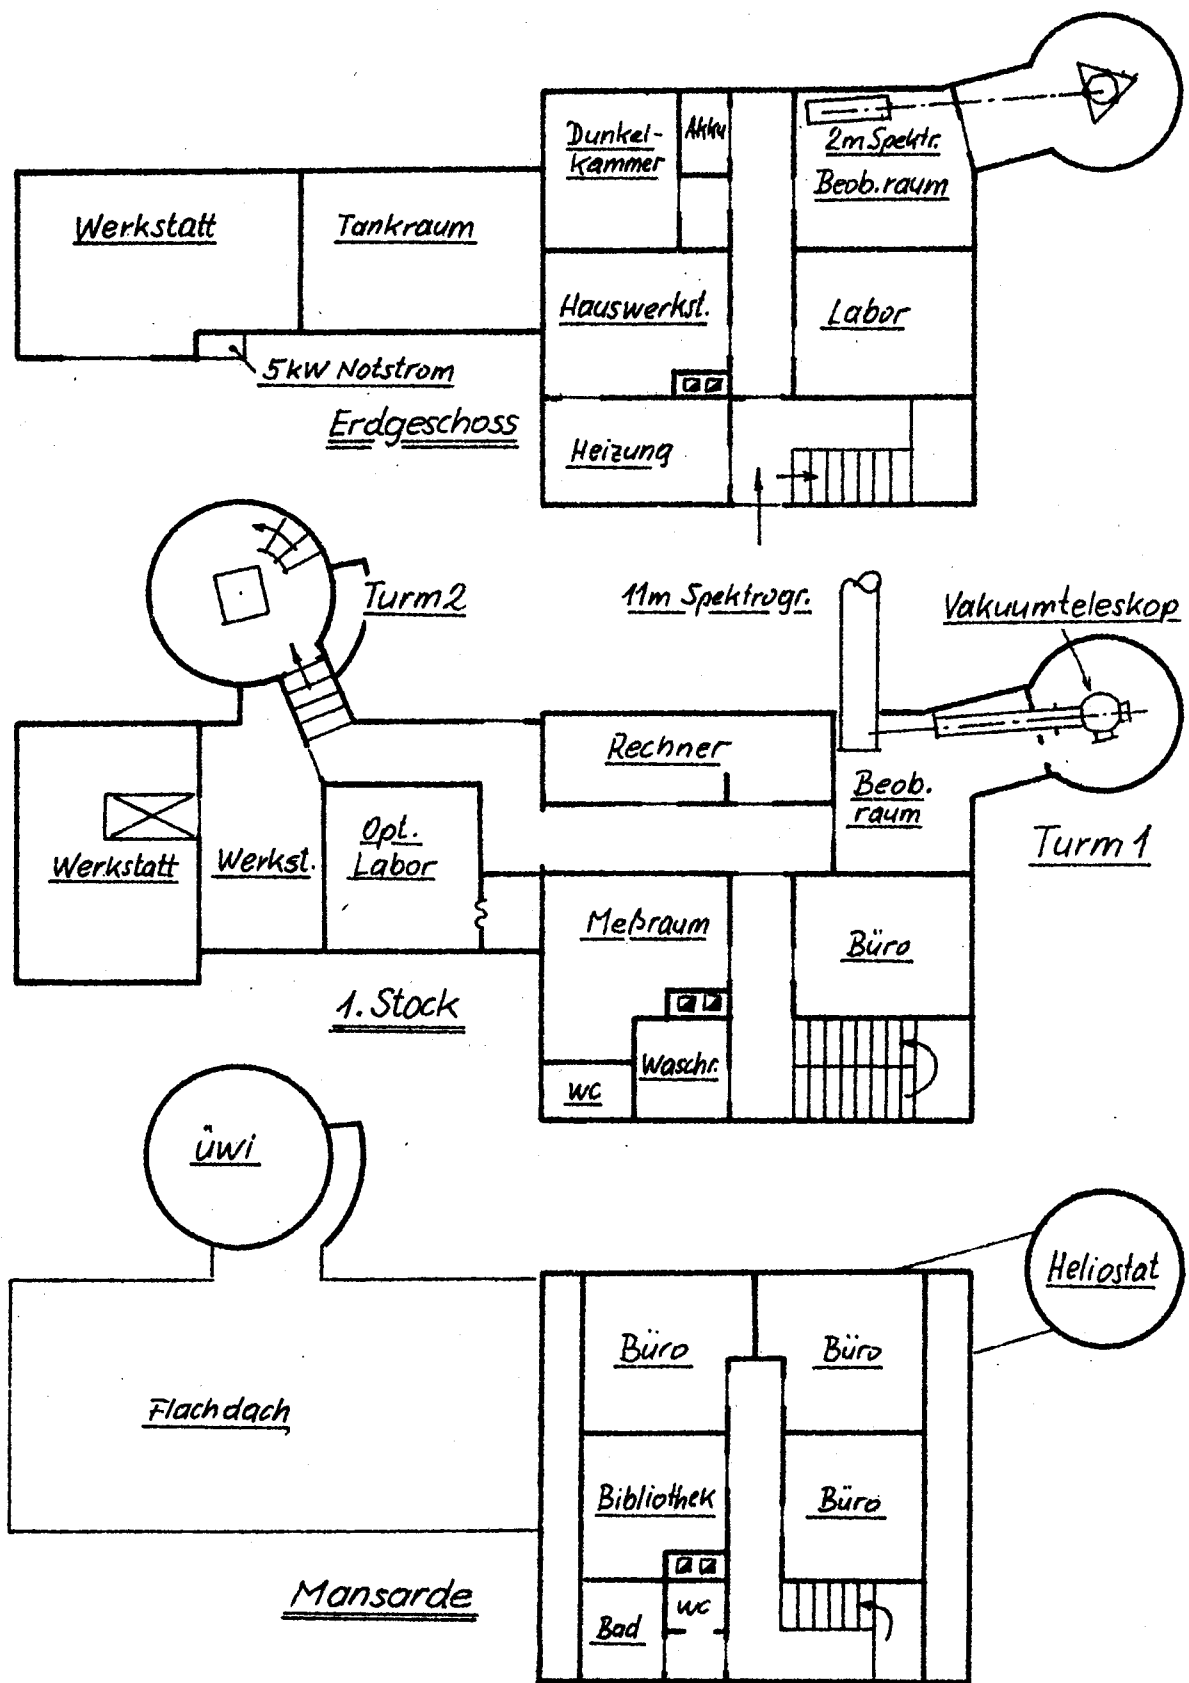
Sonnenobservatorium Kanzelhöhe, Grundrisse, M 1:200
